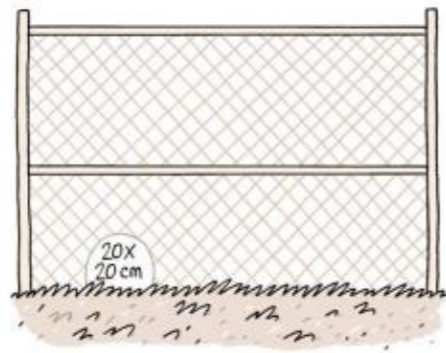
Passage à faune de 20x20 cm sur un grillage à mailles fines. (Source : Bruxelles Environnement)
